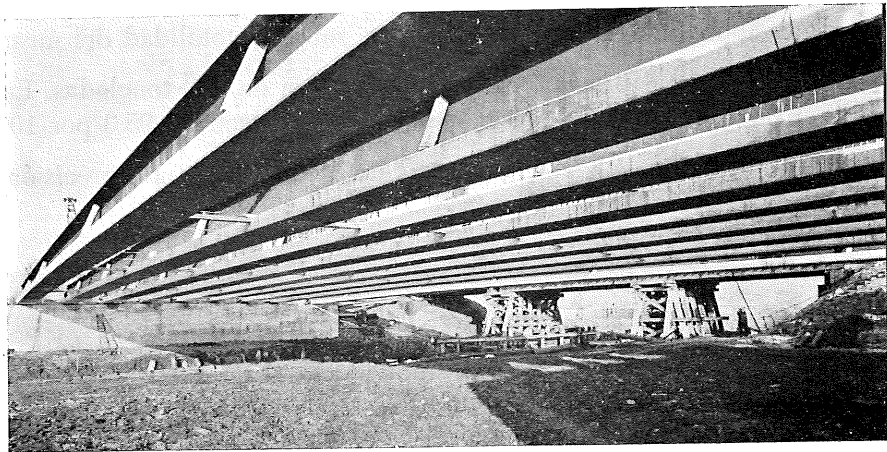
Las diez vigas Preflex del tablero colocadas en obra.
